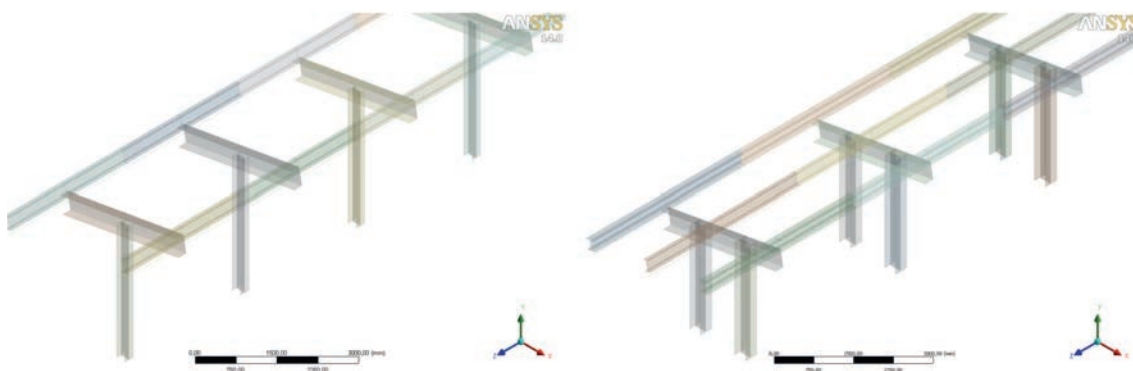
FEM-Modell der untersuchten Dachkonstruktionen mit zwei Dachpfetten (links, Variante A) und drei Dachpfetten (rechts, Variante B)
